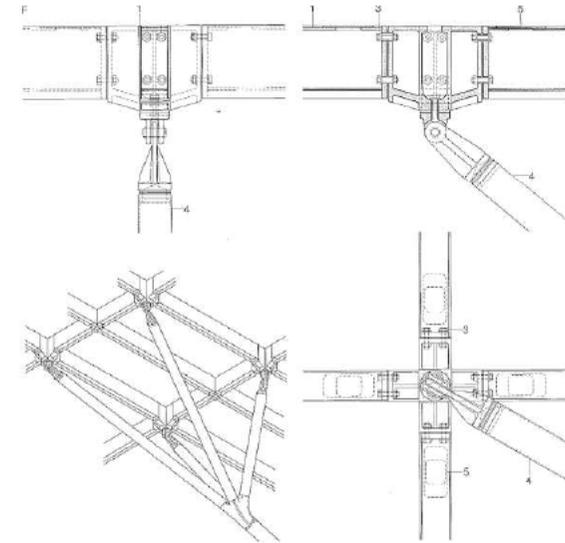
Stahlbau Verbindungen, Vorlesungsunterlage
